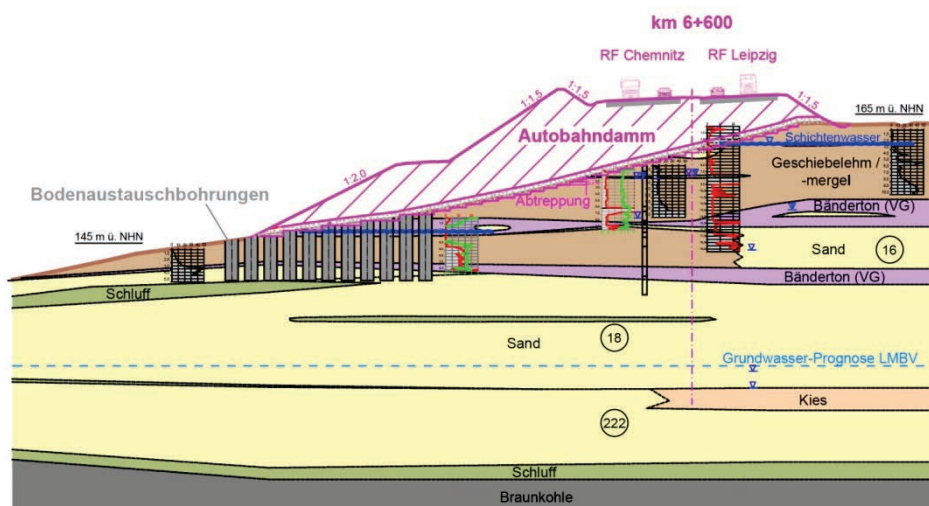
Prinzipskizze zur Dammschüttung auf stabilisierter Tagebaurandböschung (© BAUGRUND DRESDEN)
